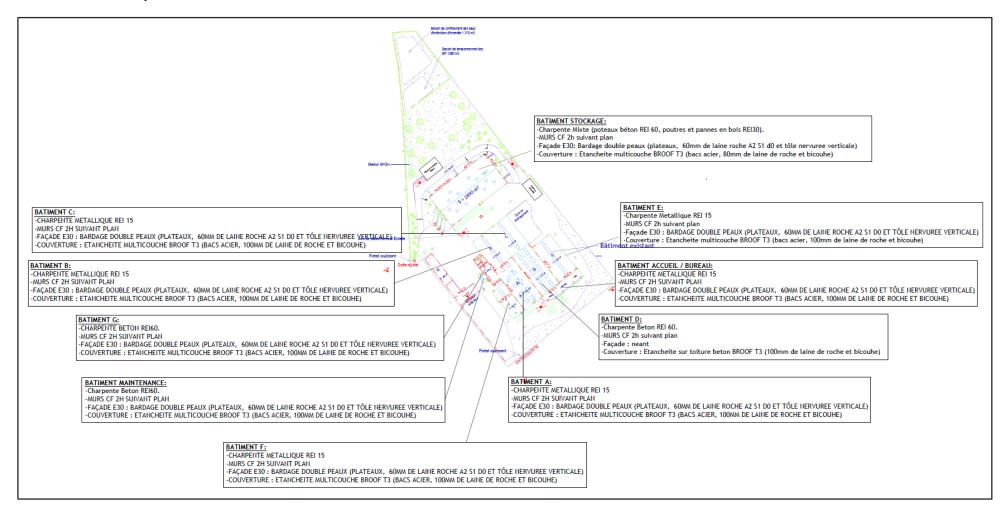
PJ24bis19- PLAN DETAIL STRUCTURE (source : sicabconstruction)
